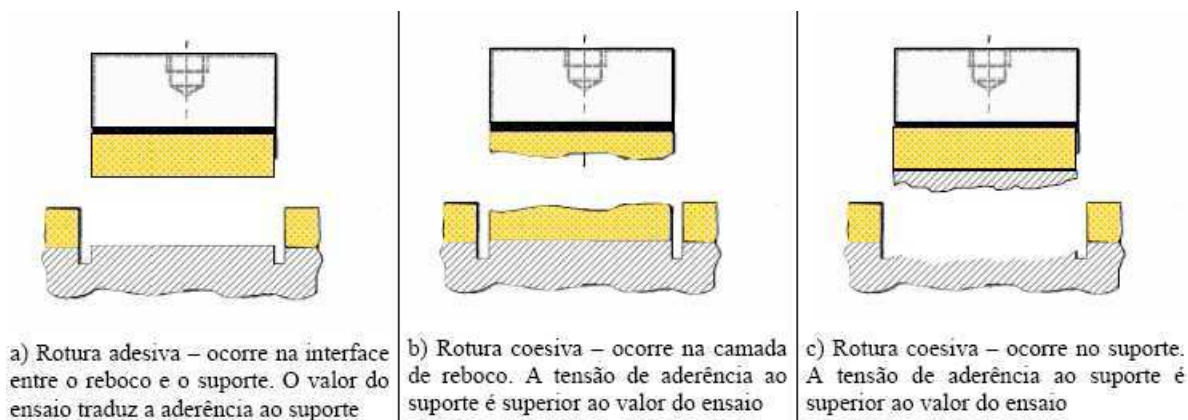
Tipos de roturas do ensaio de arrancamento
